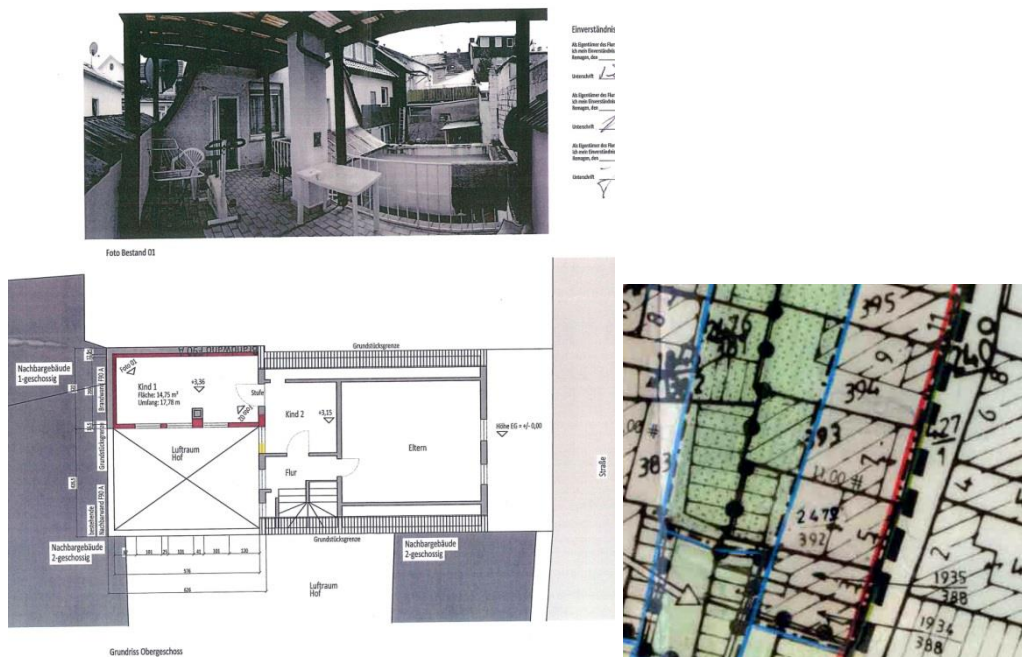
Grundriss Dachgeschoss; Auszug aus dem Bebauungsplan
